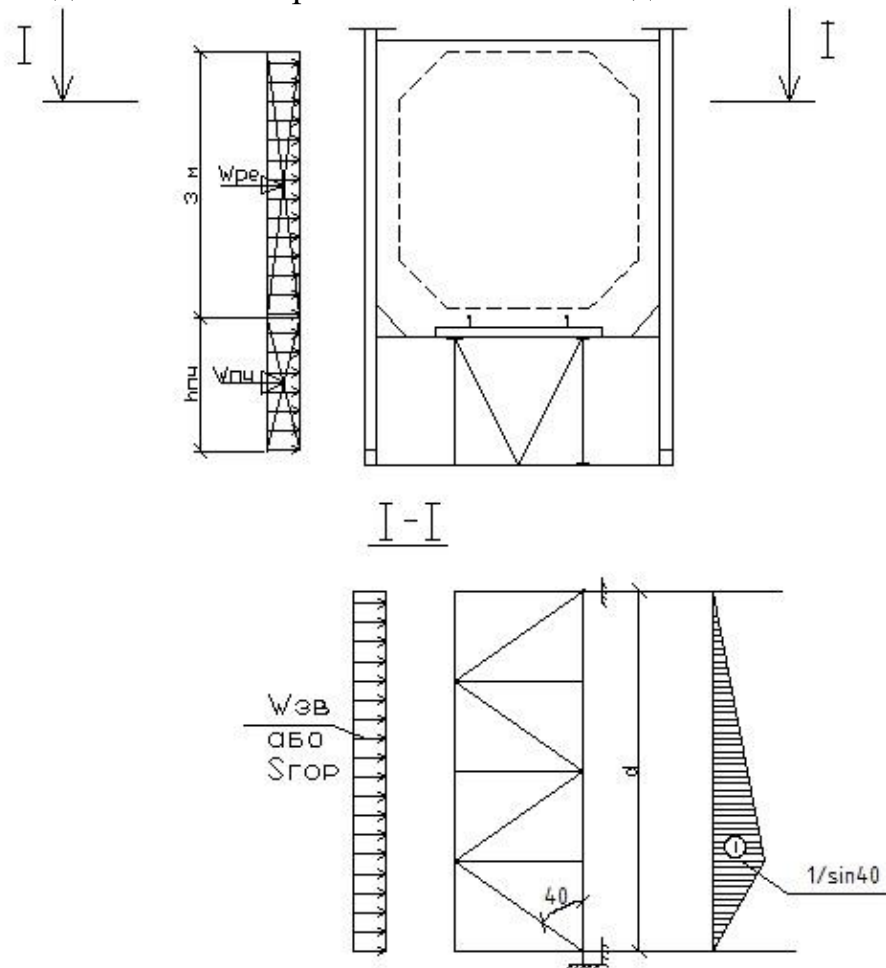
Розрахункова схема для поздовжніх зв'язок між поздовжніми балками
